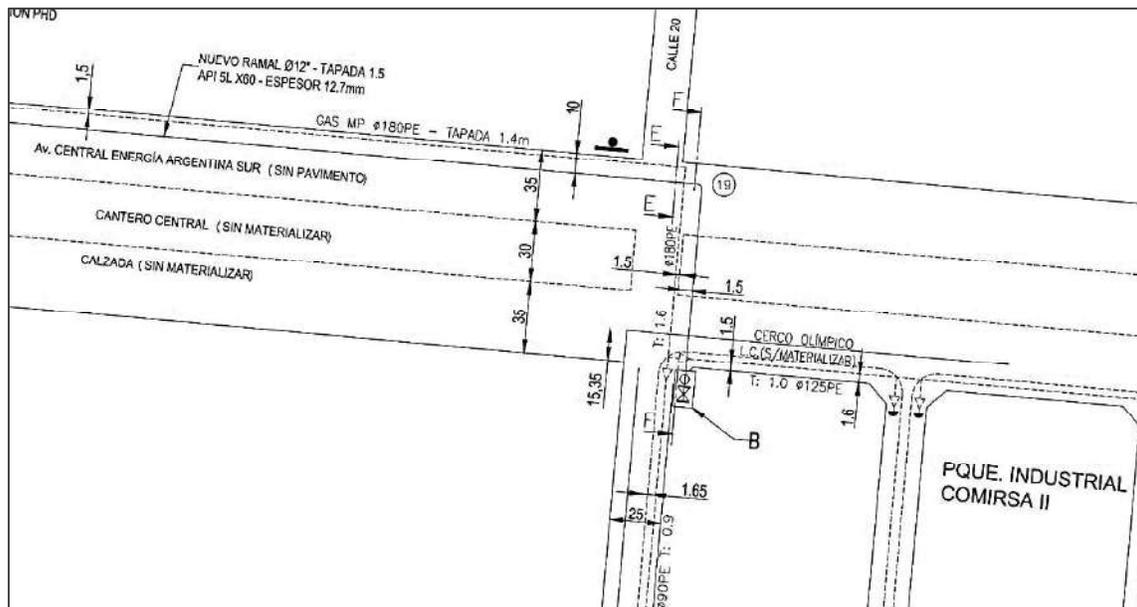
Cruce de Av. Central Energía Argentina y llegada a planta.
